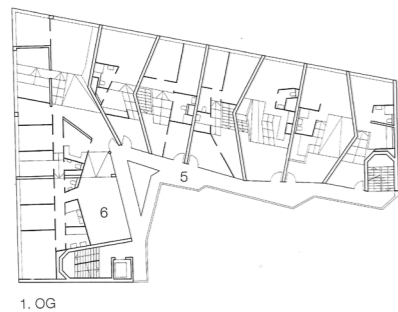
Miss Sargfabrik Grundriss 1. OG
